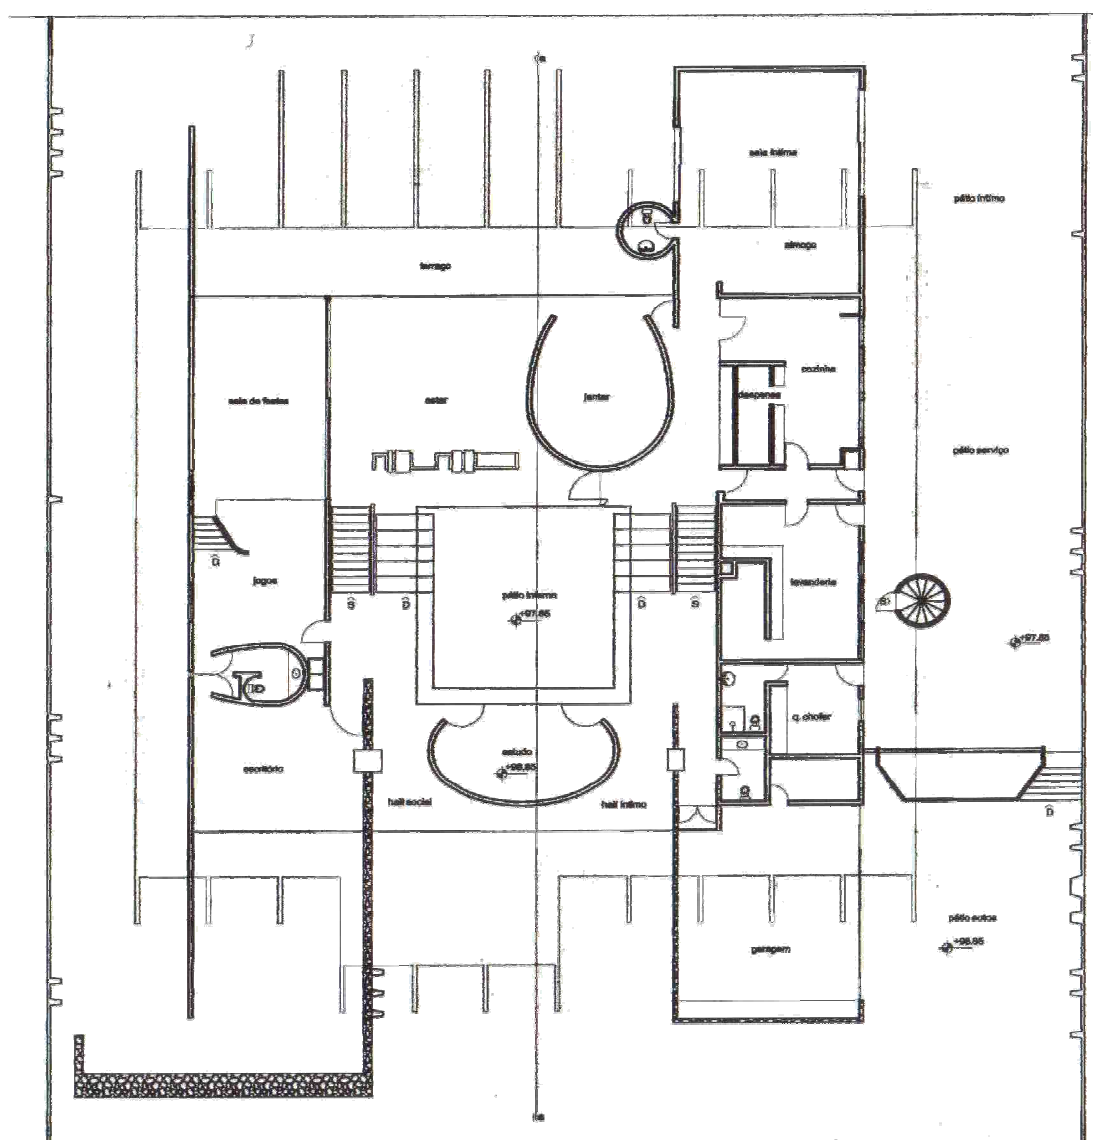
PLANTA PAVIMENTO TÉRREO
